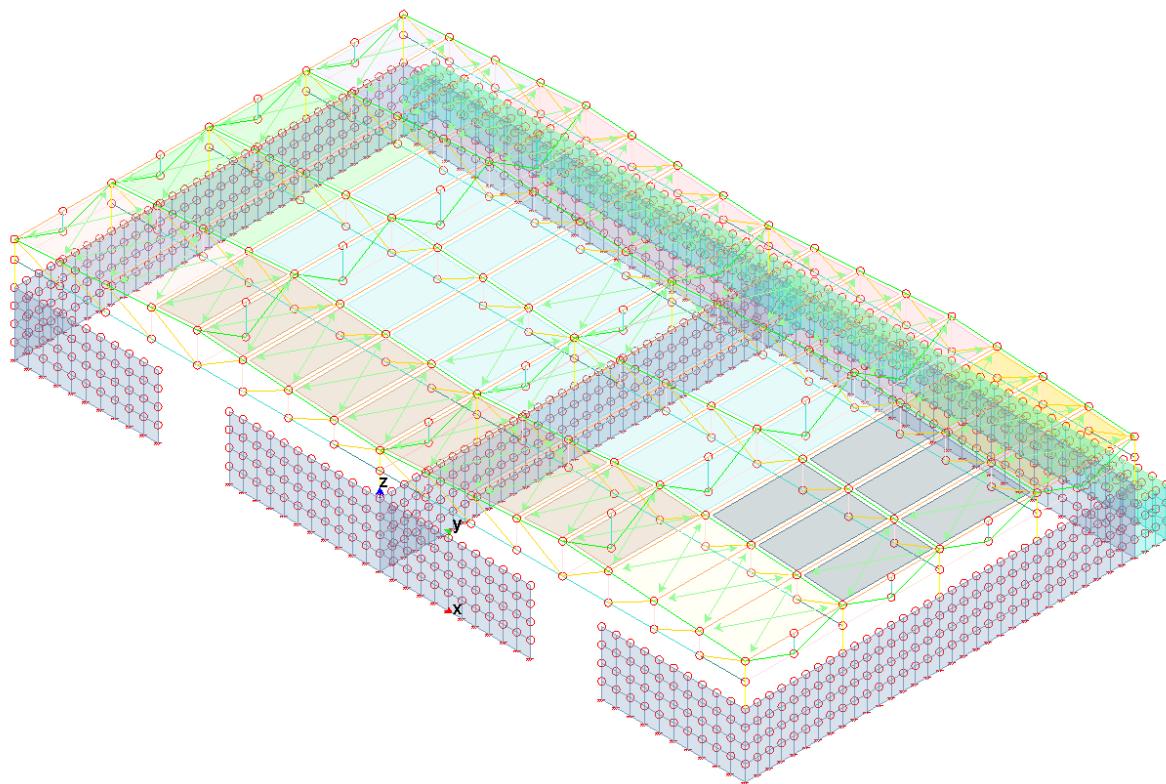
Vista monofilare del modello 3D dell'elevazione
